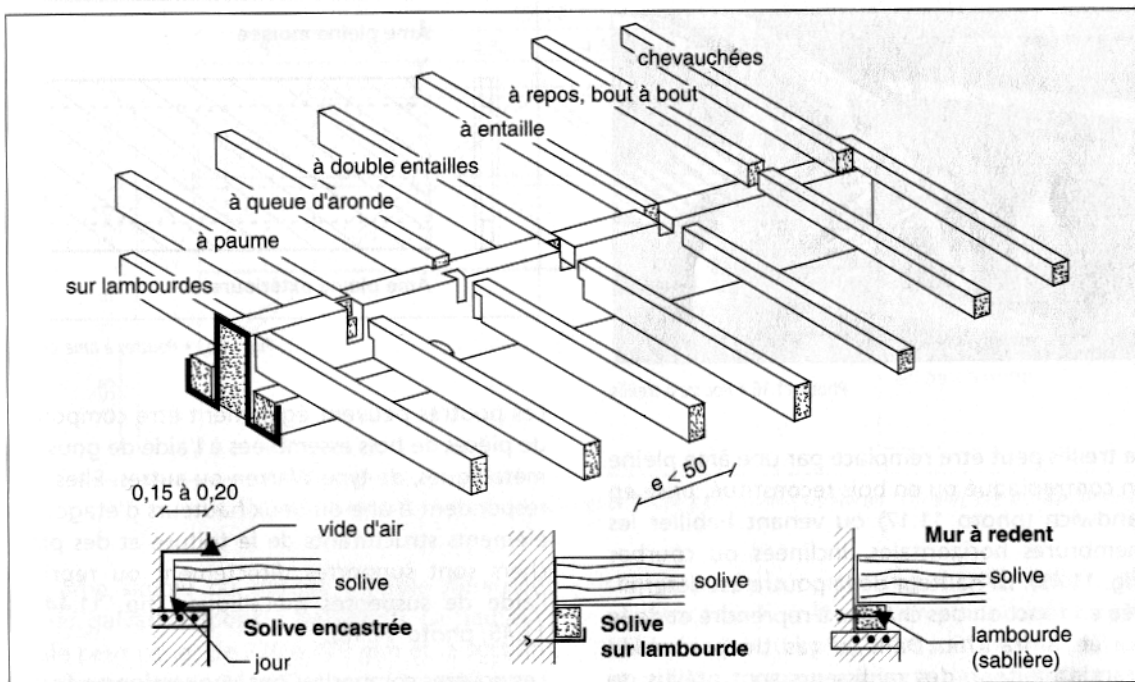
• Principes d'appui d'une solive sur une poutre ou sur un mur.
